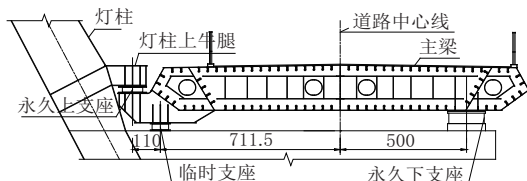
主塔侧上牛腿及支座布置立面图(单位:cm)
